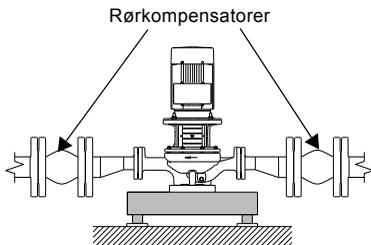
TP-pumpe installeret med større rørkompensatorer
